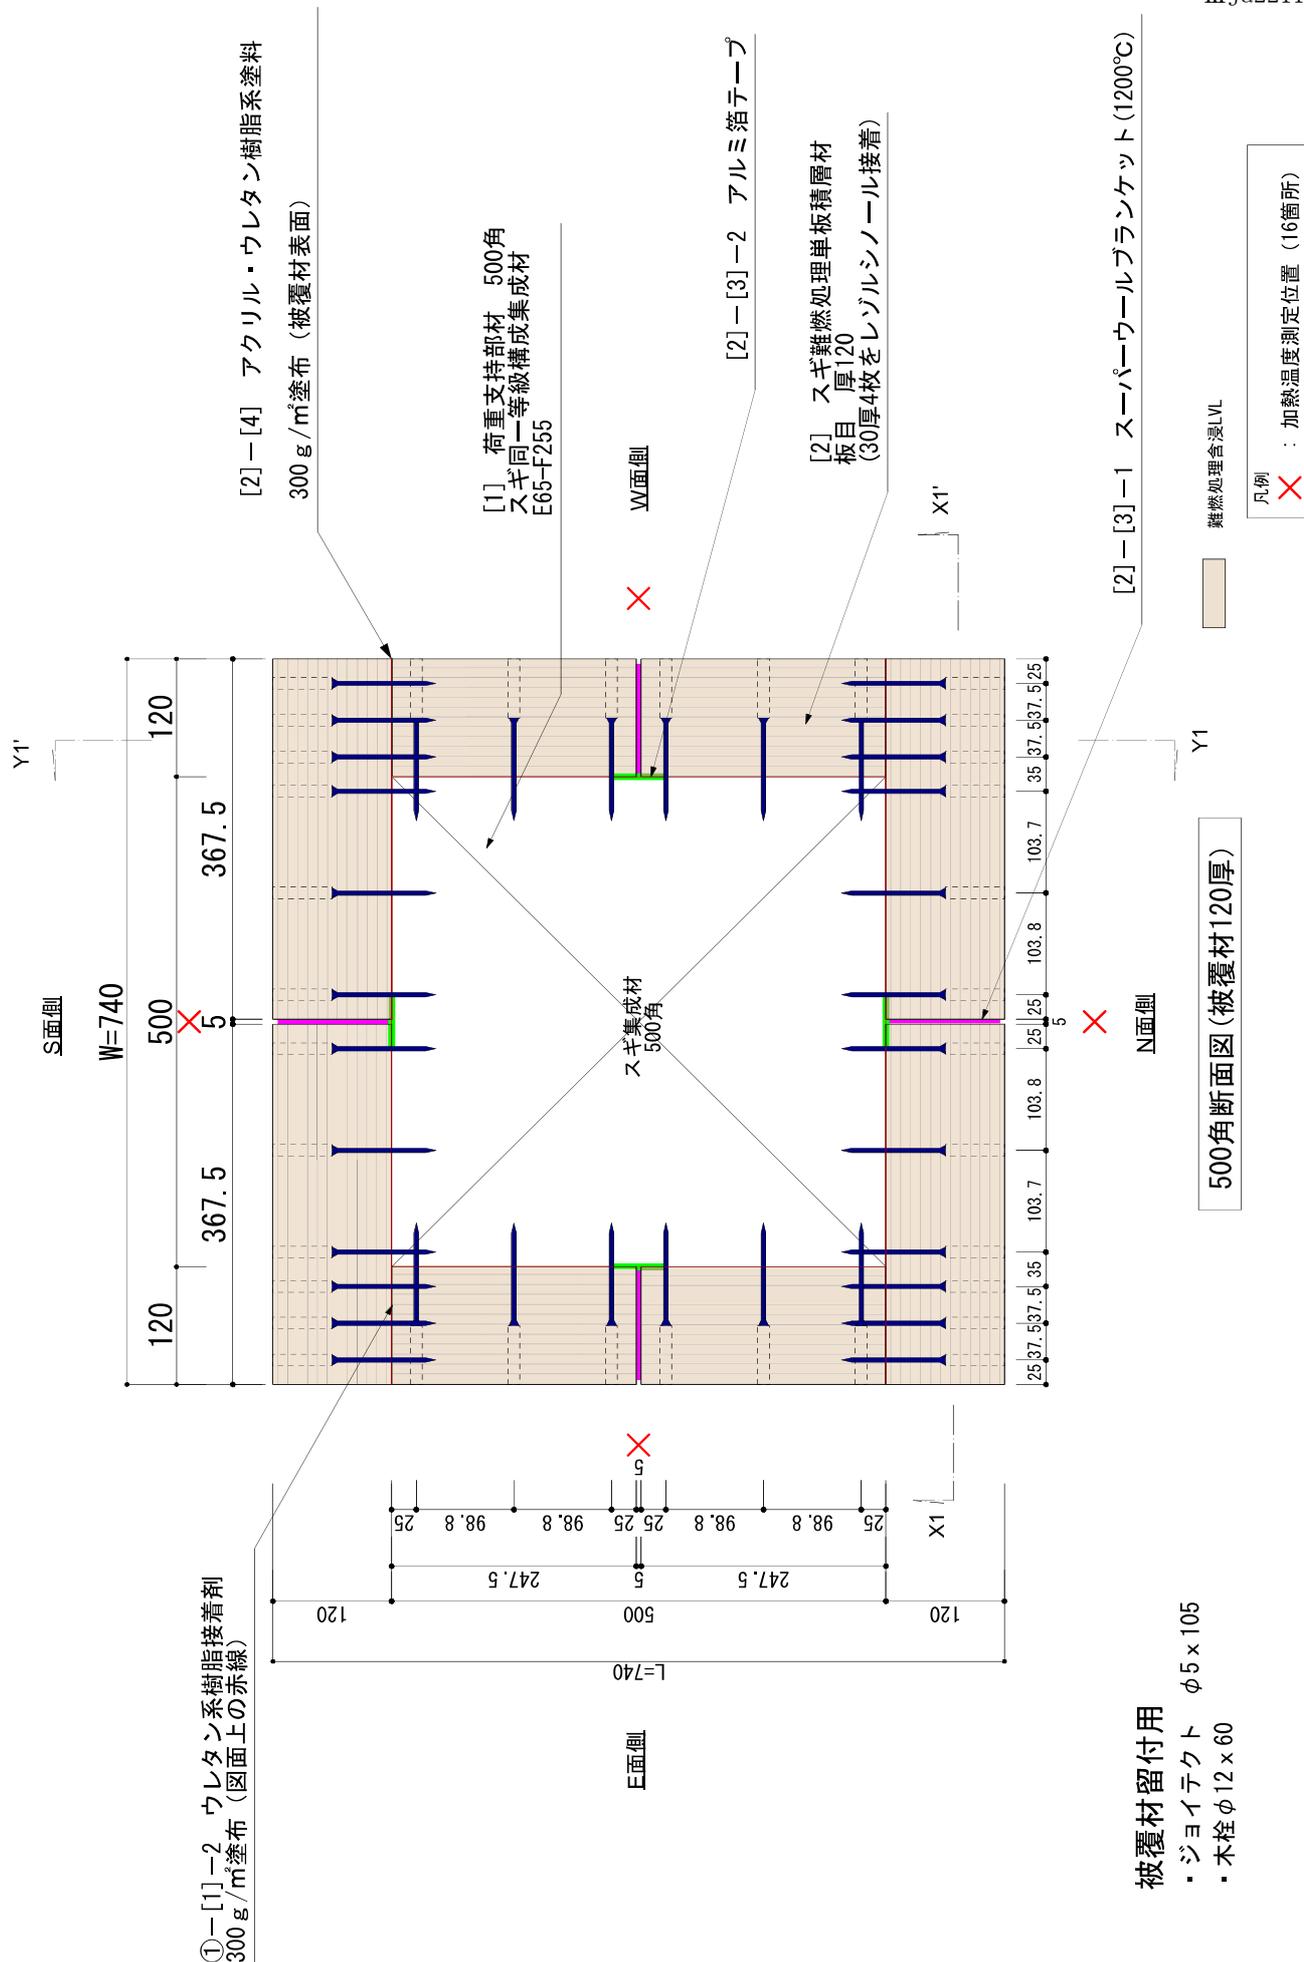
試験体の構造・寸法・温度測定位置 (寸法単位:mm)
